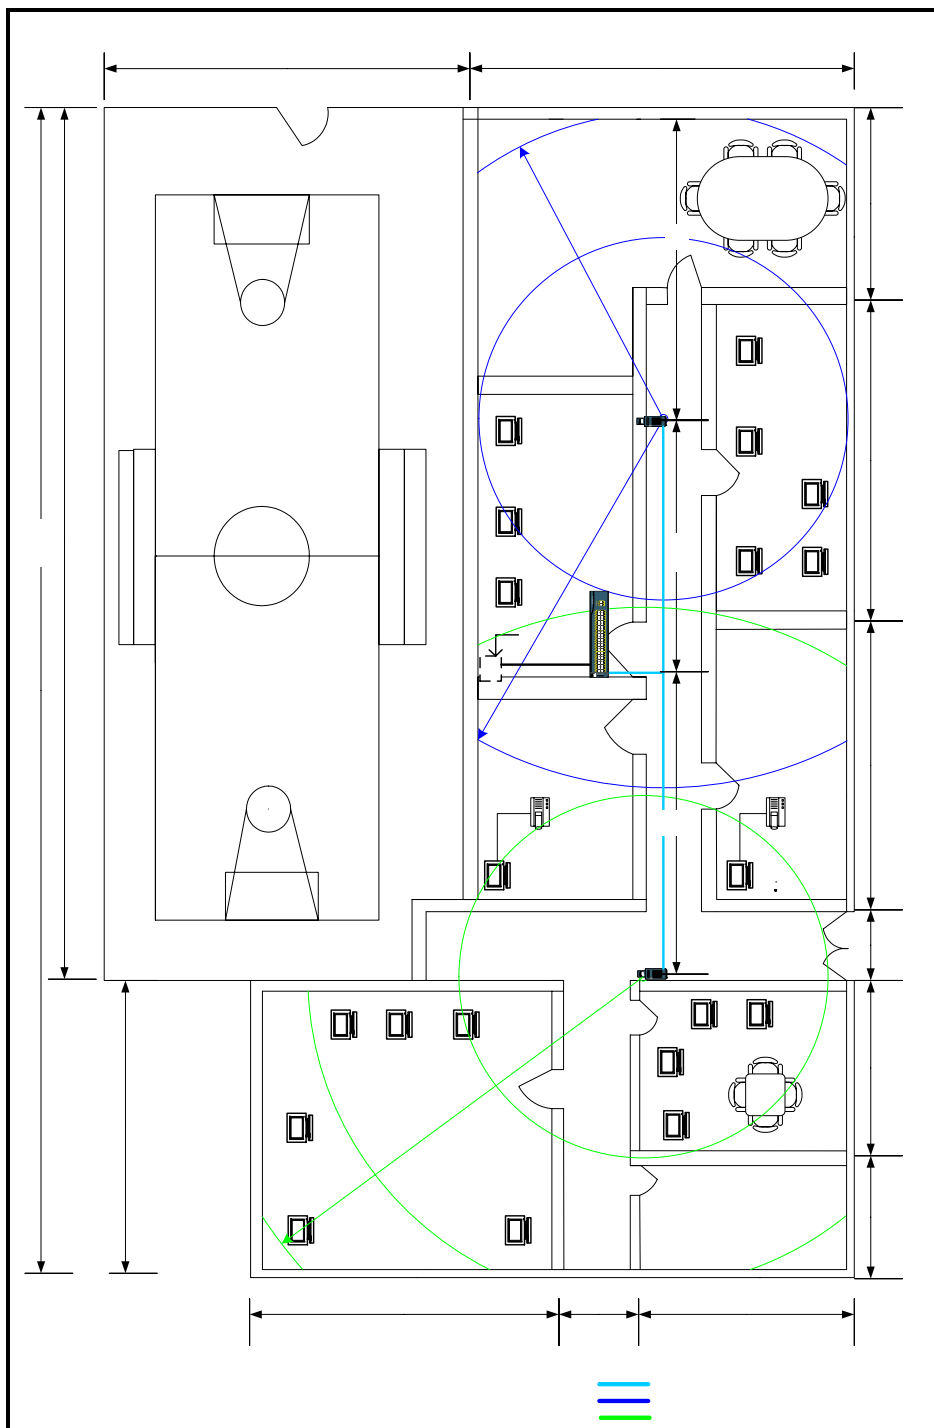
Plano de la red WLAN de la planta baja del edificio de Párvulos
